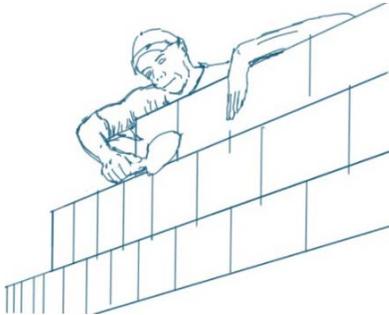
Levantamiento tradicional. Fuente: Elaboración propia
